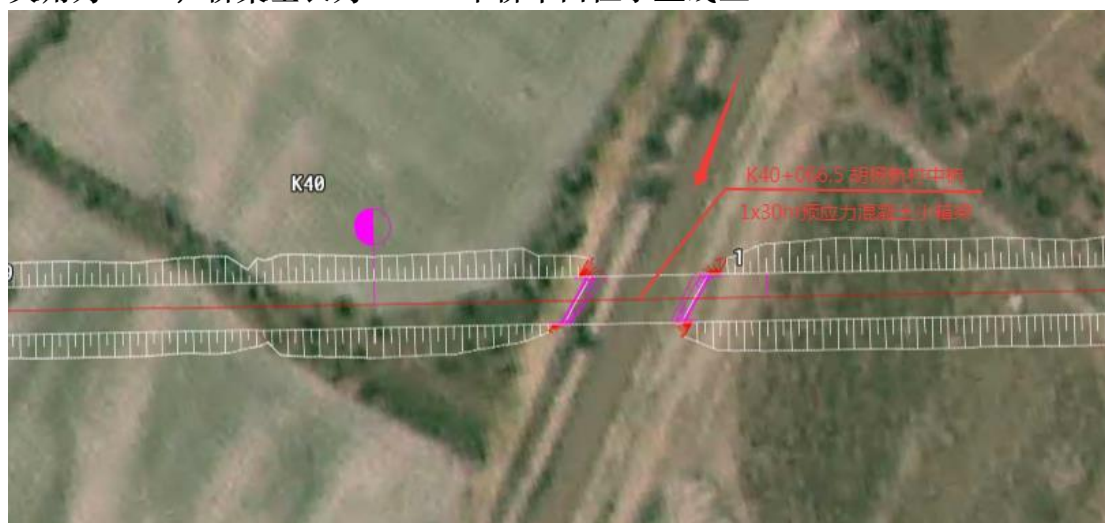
K40+066.5 胡杨新村中桥桥位平面布置图
